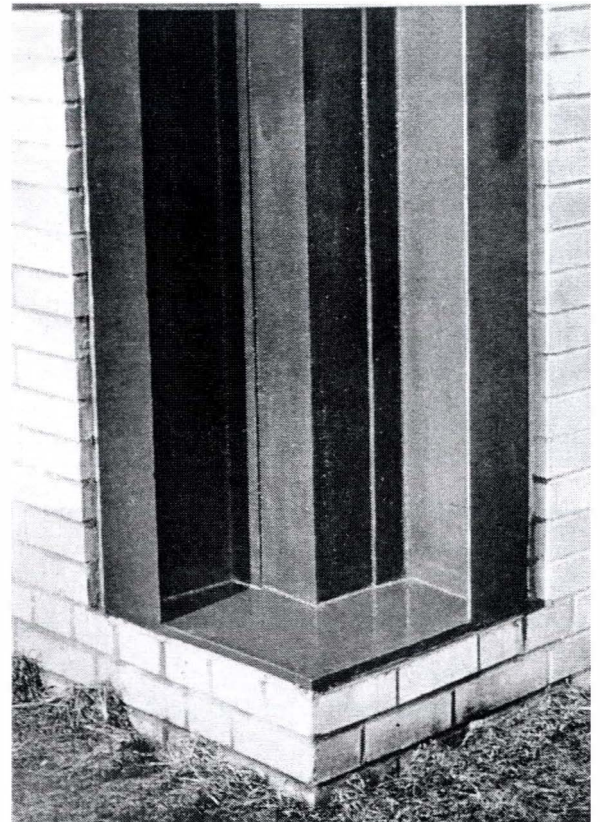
Detalle constructivo de Mies Van der Rohe
